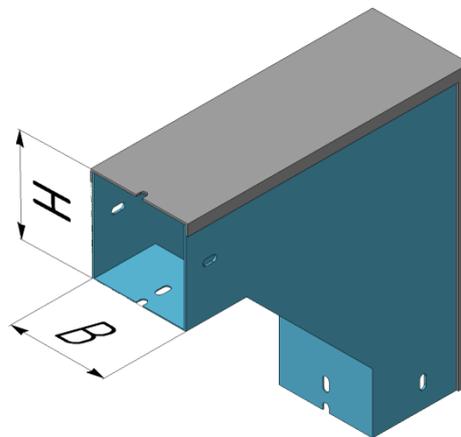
Короб угловой для поворота вниз под углом 90° типа КУН. Общий вид
